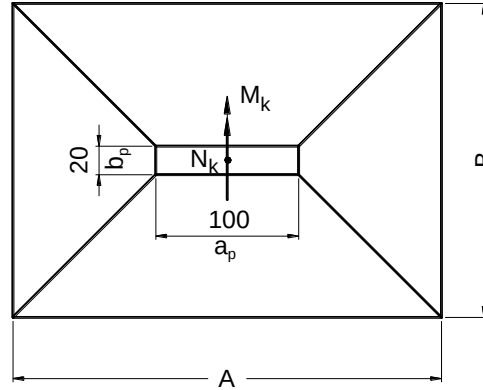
Ações aplicadas na sapata isolada e notação das dimensões.
